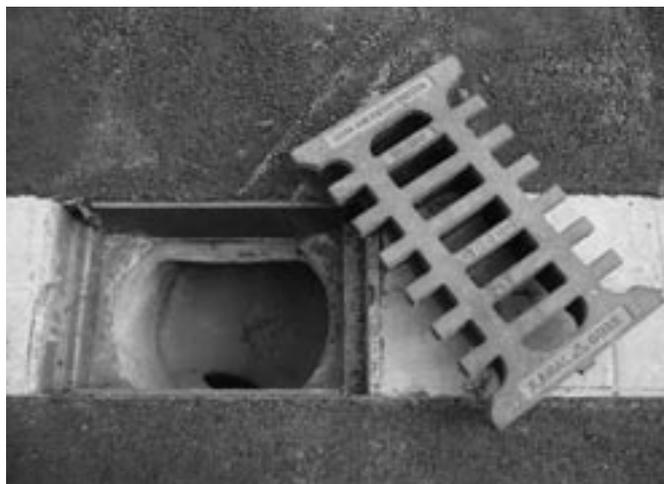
Entwässerungsdetail, geöffneter Einlaufschacht
